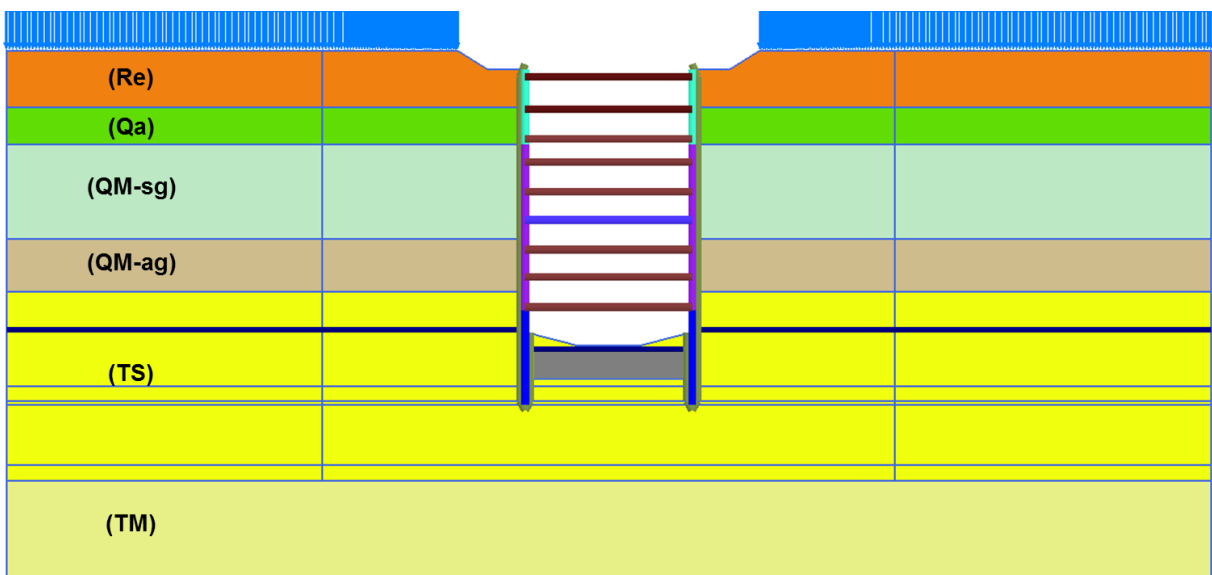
Fase 26: Décima segunda fase de escavação, até ao fundo de escavação, ou seja, 39,09m
